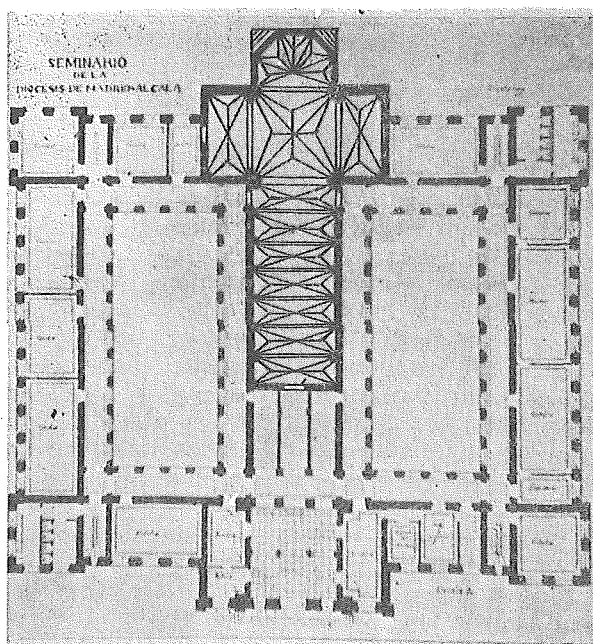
M. de Olabarría: Planta del Seminario Conciliar.
